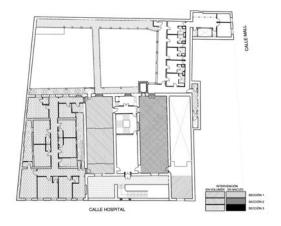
Plano de la planta piso primero, con indicación de las diferentes intervenciones (Jordi Salvat)
